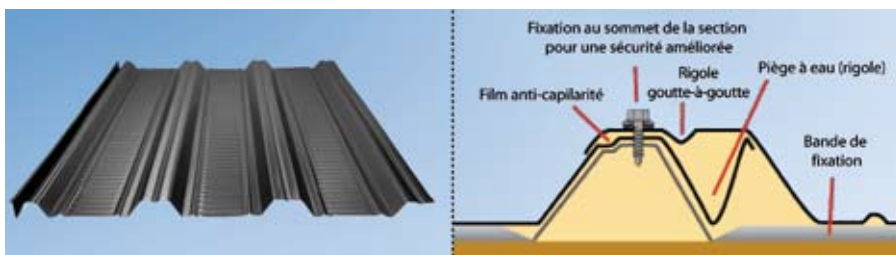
Revêtement de toit Plannja 40 (destiné à l'utilisation sur de faibles pentes de toit, de 3 à 6 degrés) Source : www.plannja.se
